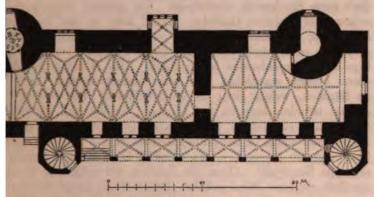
Schloss zu Offenbach. Grundriss.
